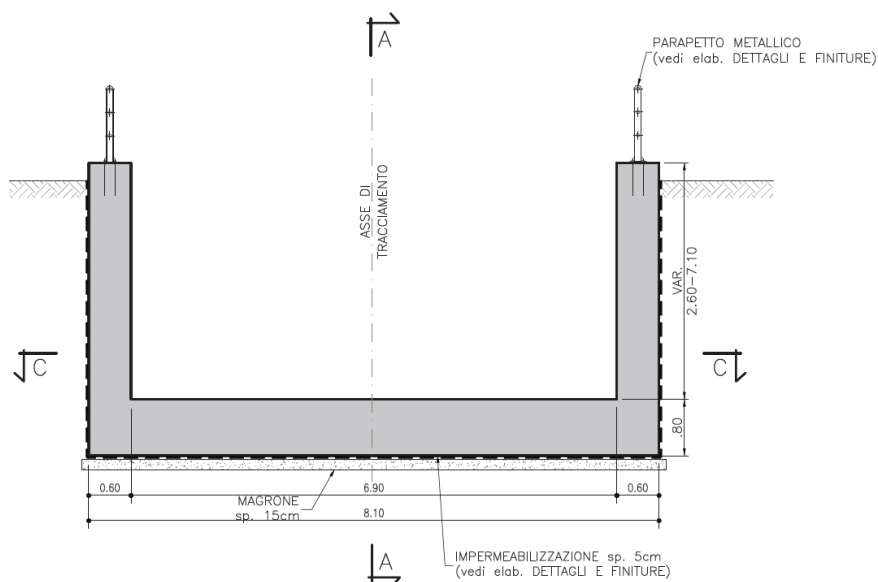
Muro d'imbocco - Sezione trasversale
